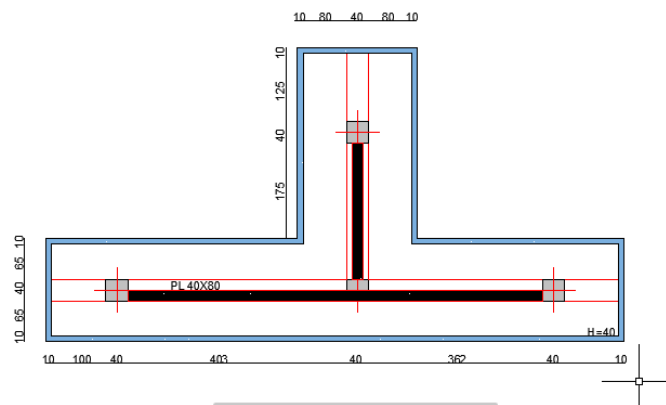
Schéma de ferrailage de Semelle filante (1045x170x40) cm et de ferrailage de poutre libage
